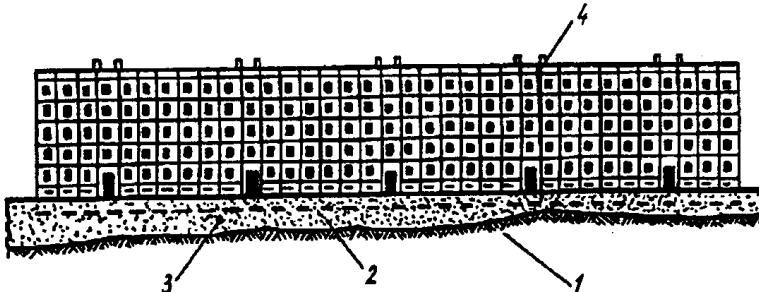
Схема деформации крупнопанельного жилого дома из-за неравномерной деформации грунтового основания при аварии трубопровода:
